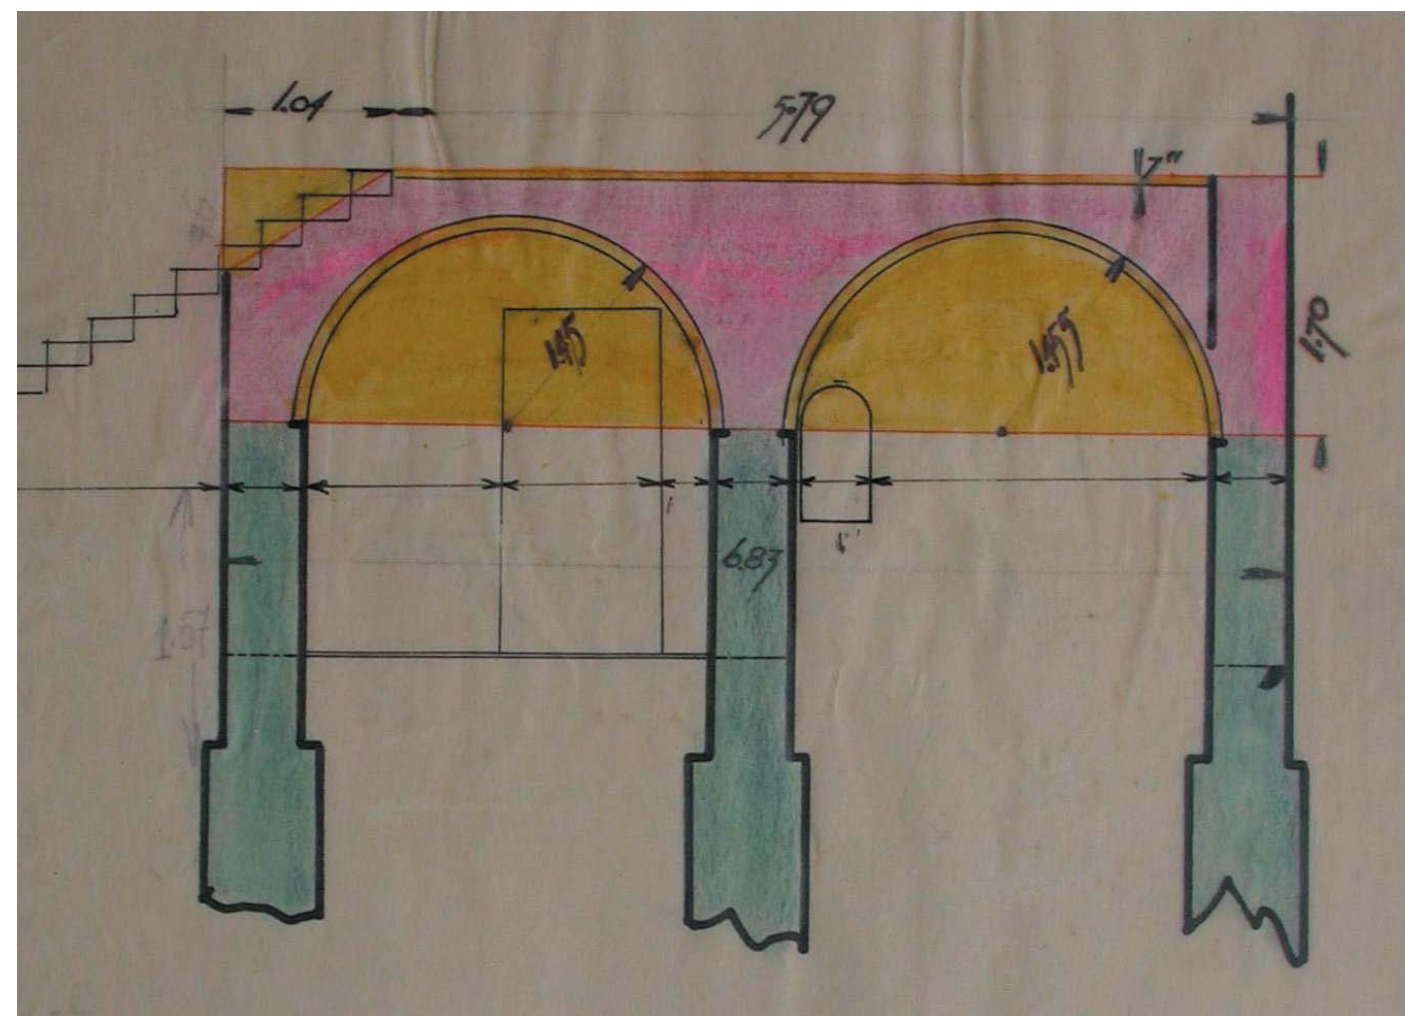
Schizzo di cantiere, tipologia Lacchi
